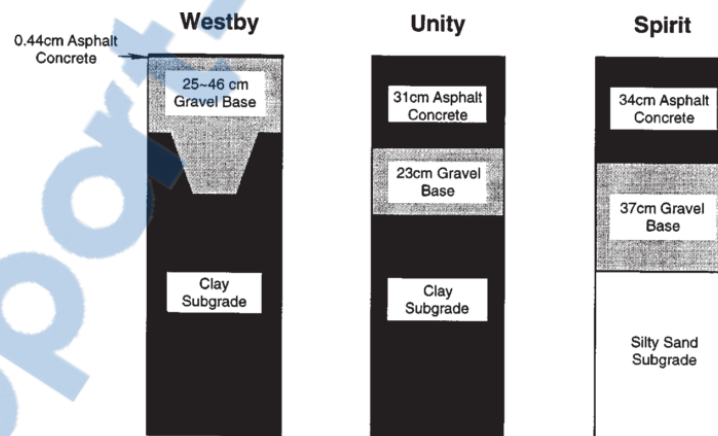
Structure des chaussées utilisées (Benson et coll. (1998))
